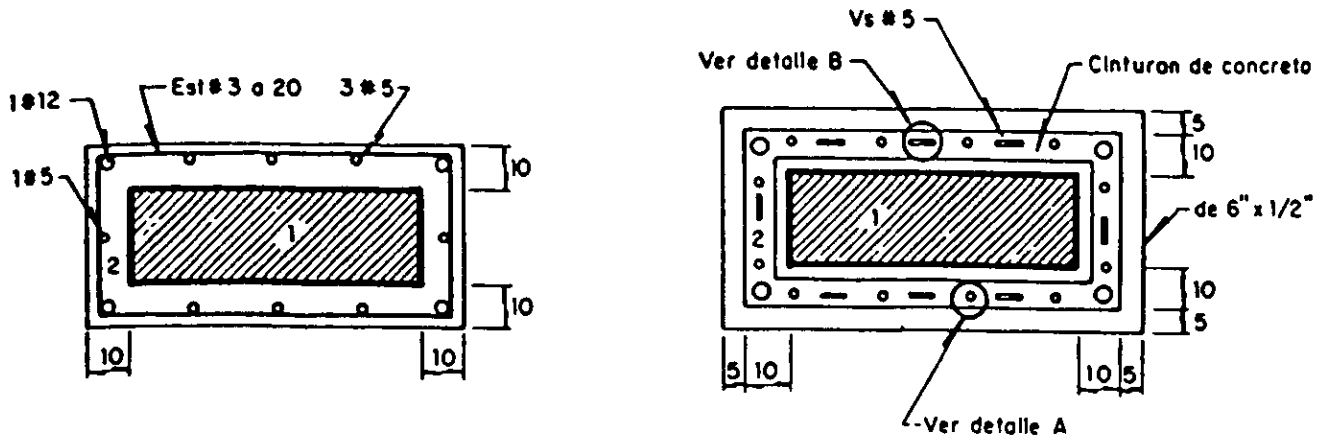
Encamisado de columnas en la primera rehabilitación
